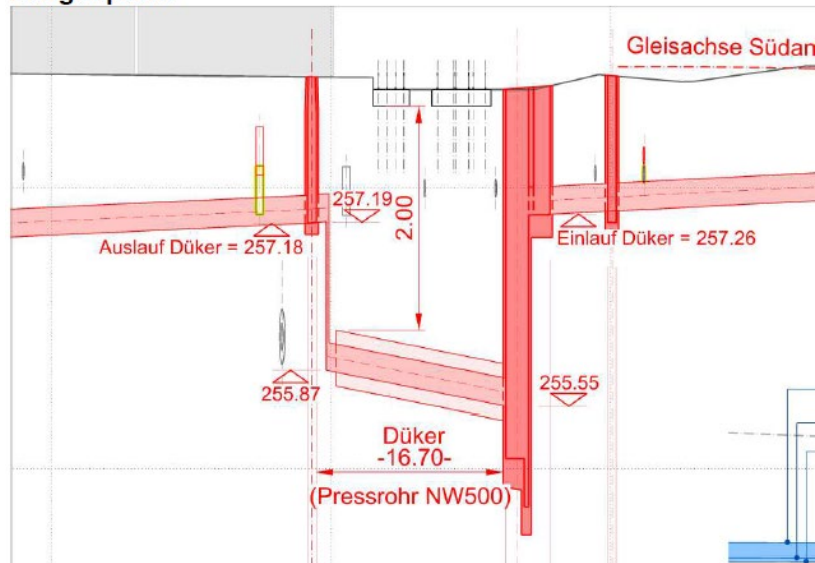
Längenprofil Entwässerung Auhafenstrasse (Ausschnitt)
